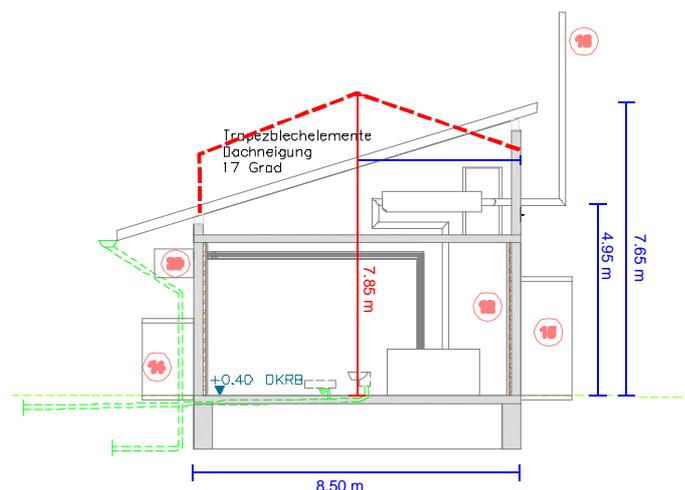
Vertikalschnitt durch das bestehende Generatorhaus und Bestimmung eines fiktiven Dachfirsts (Plangrundlage: Sewald GmbH & Co.KG, Eingabeplan/Schnitte, Plan-Nr.2009-0366-10, 09.04.2009)
